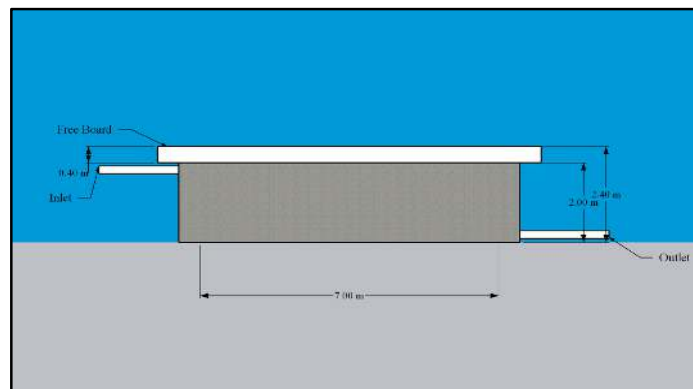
Desain Sludge Separation Chamber (SSC) Tampak Depan
